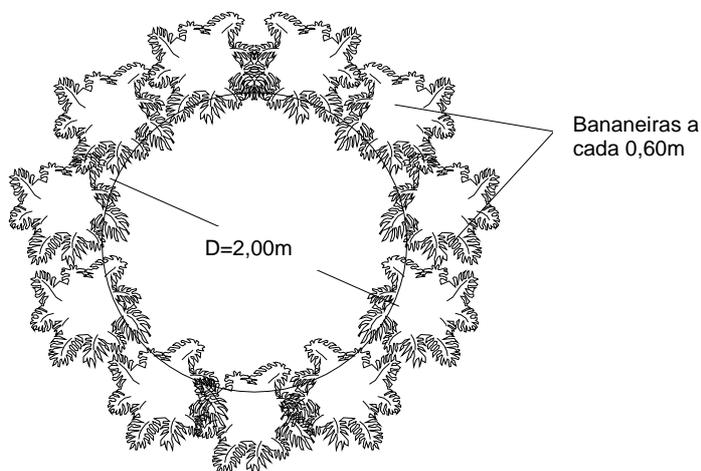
Planta baixa do círculo de bananeiras. *Dimensões em metros (m).
